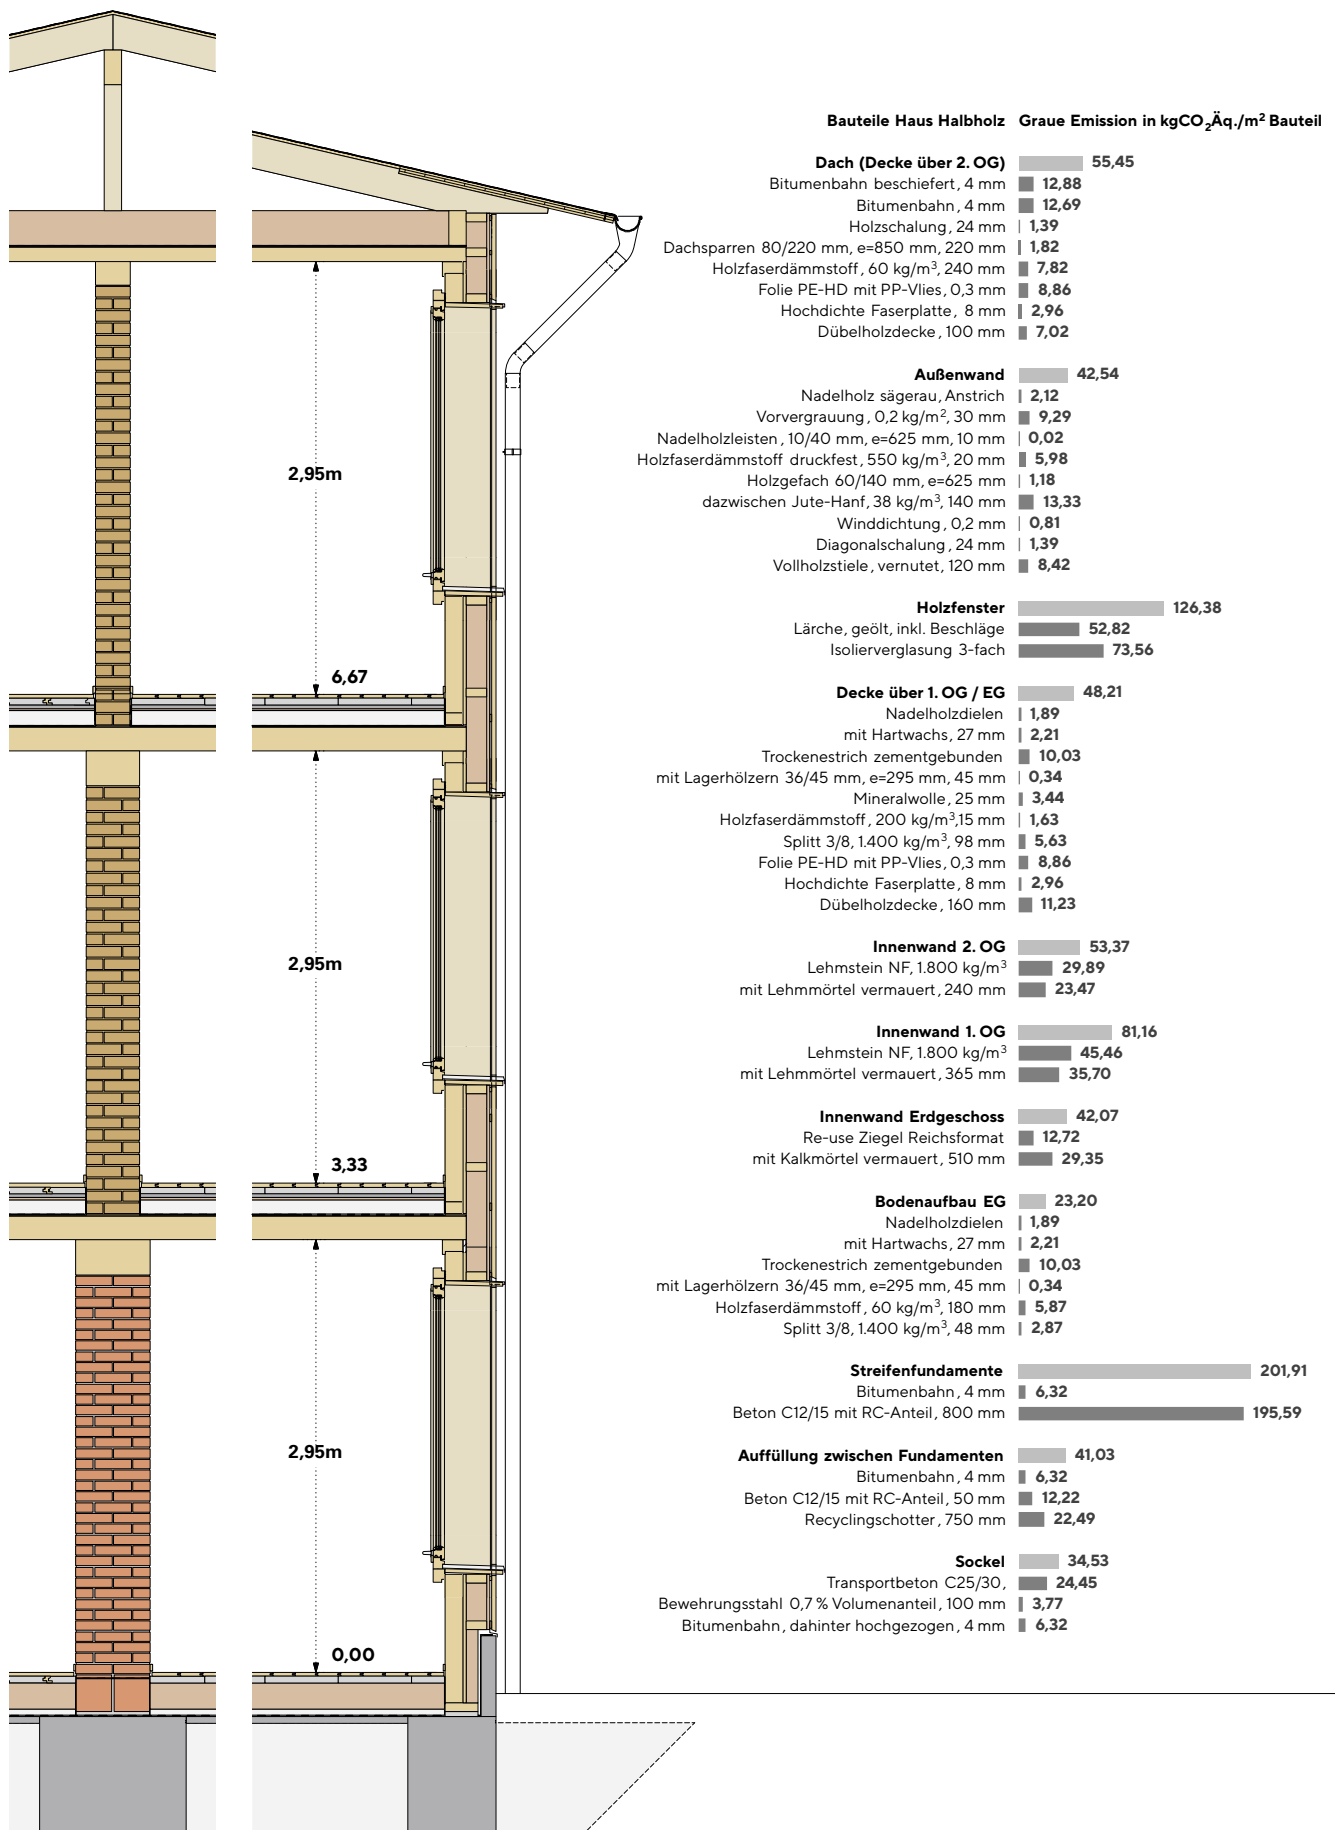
Detailschnitt Halbholz, Quelle: Florian Nagler Architekten
